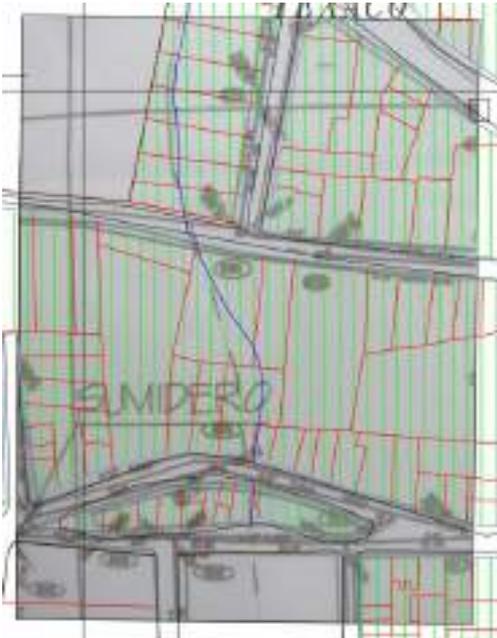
, foto plano del plan maestro sobrepuesto al de servicios del EOT en donde se puede ver que la proyección de canalización iba en diagonal y no en ángulo recto
